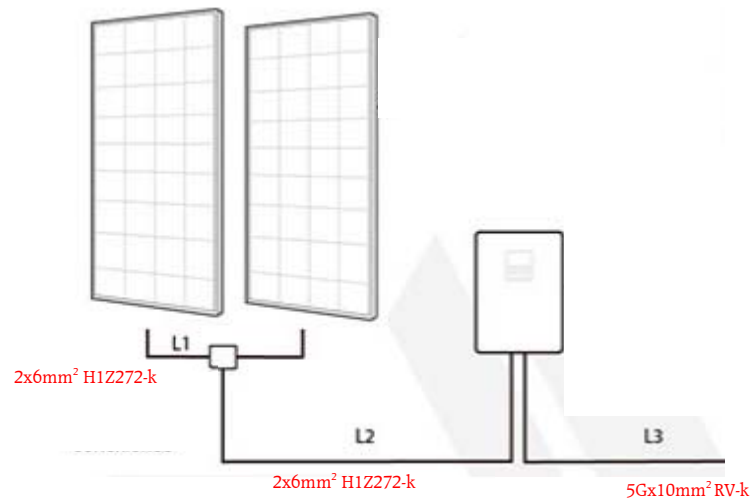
Esquema tipo de la Instalación. Secciones del cableado
